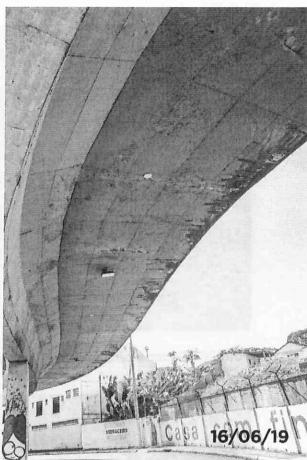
Vista geral frontal inferior da Passarela, detalhe ausência de pingadeira laterais, processo de infiltração e armaduras expostas.
